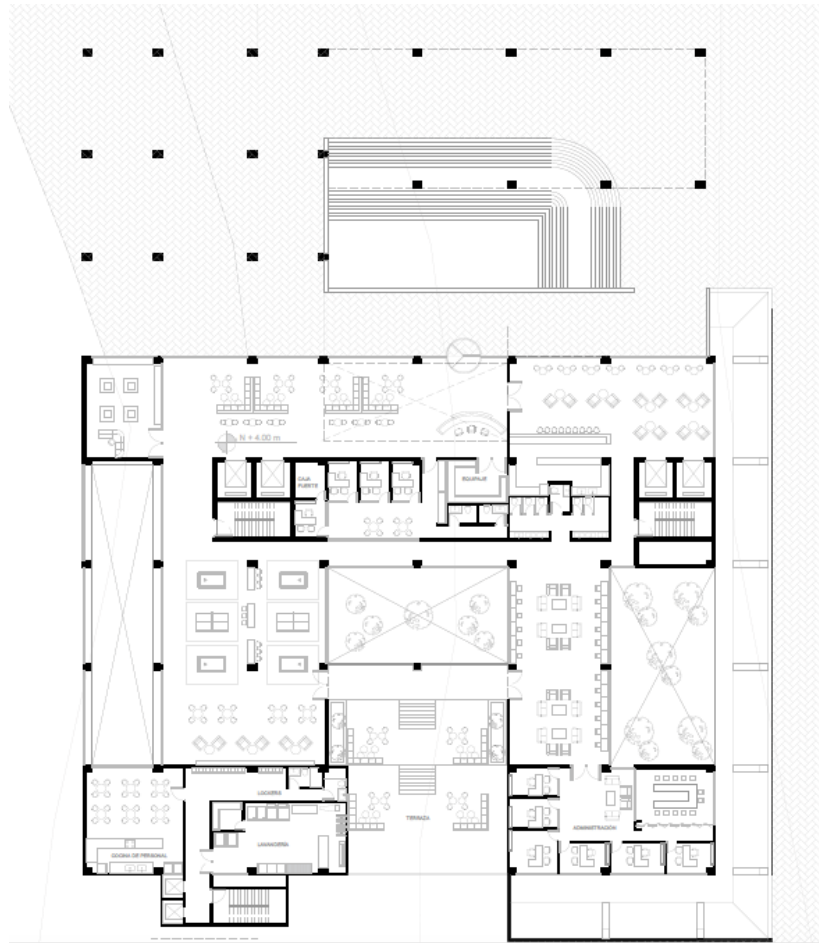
plano de planta baja de Ícaro. Fuente: estudiante de arquitectura Tsaiwa Cotacachi.
